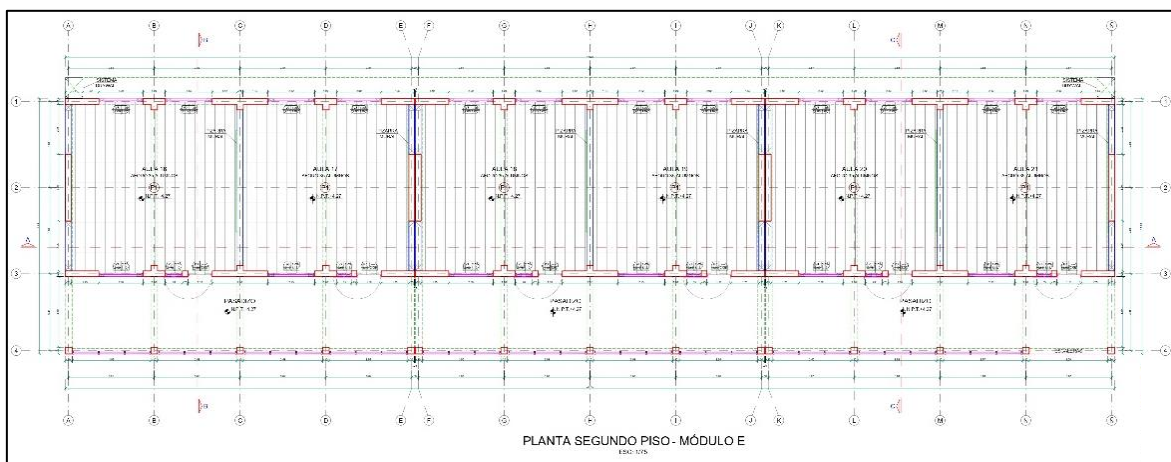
Distribución arquitectónica del módulo "E" - Planta Segundo Piso
